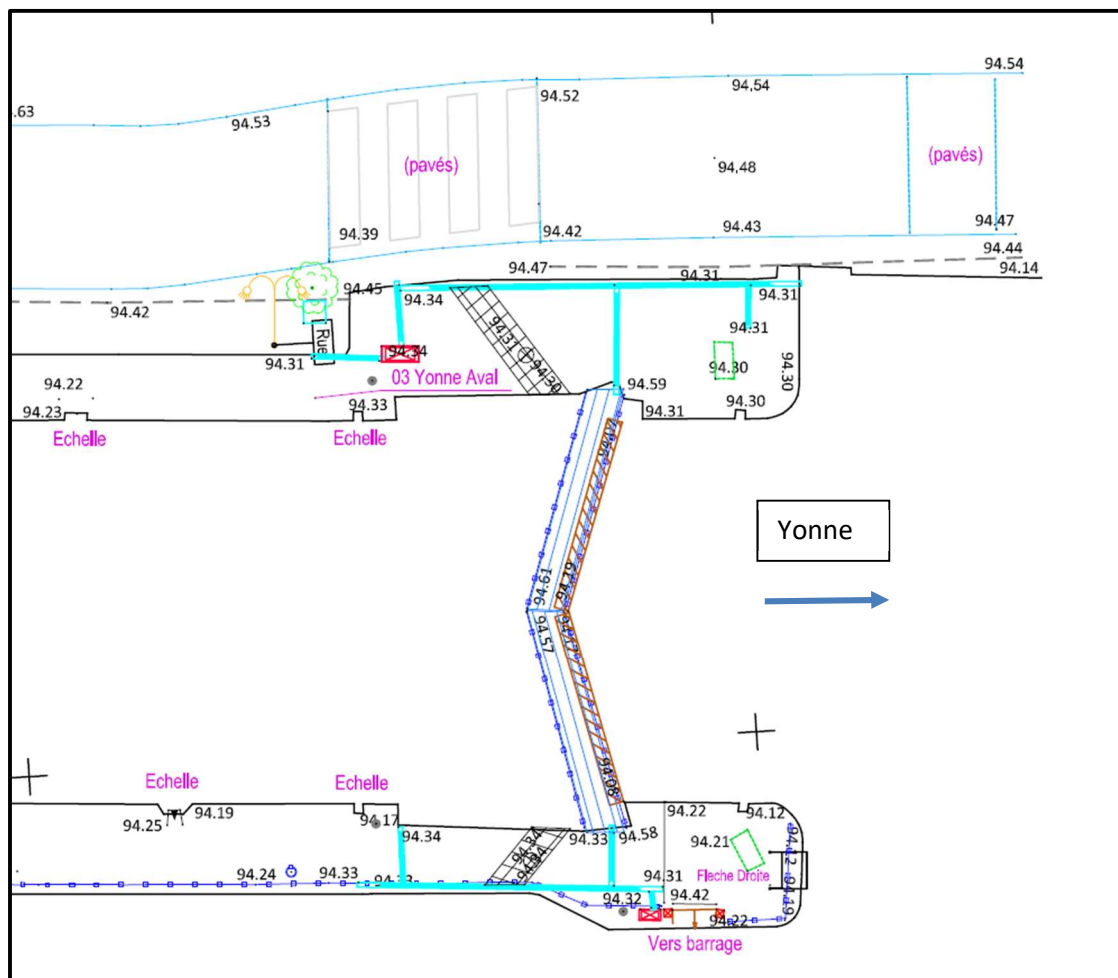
Vue en plan de la tête aval (Source : plan topo dressé par GEOESAT)
